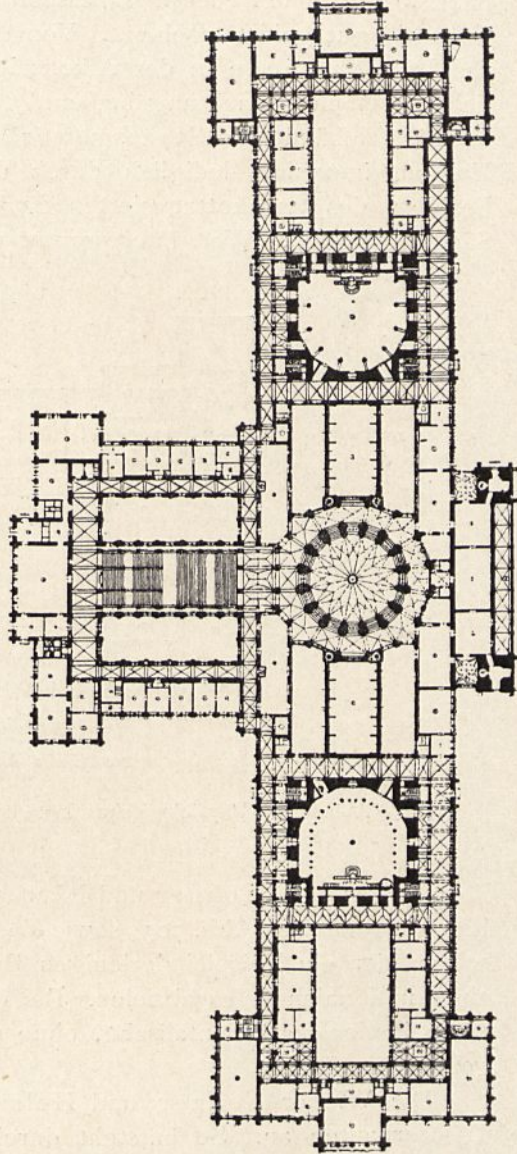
Parlamentshaus in Budapest. Grundriß des I. Stocks.
